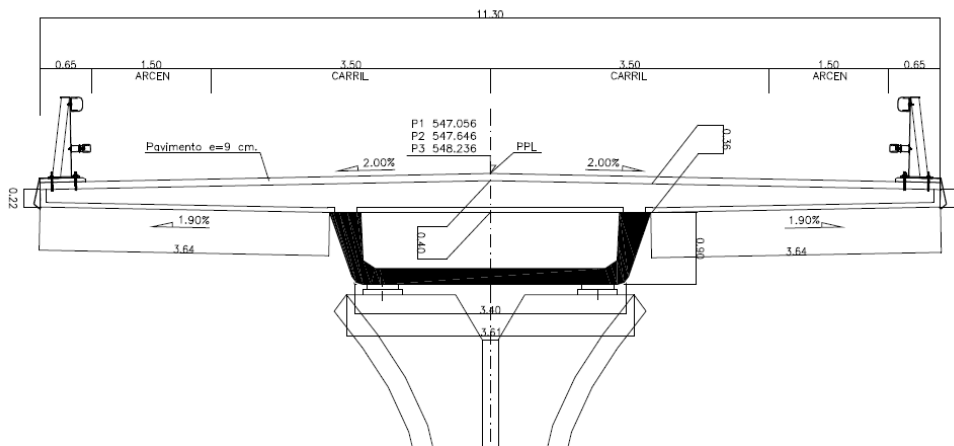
Detalle Estructura 6 y 8 Alternativa 1
